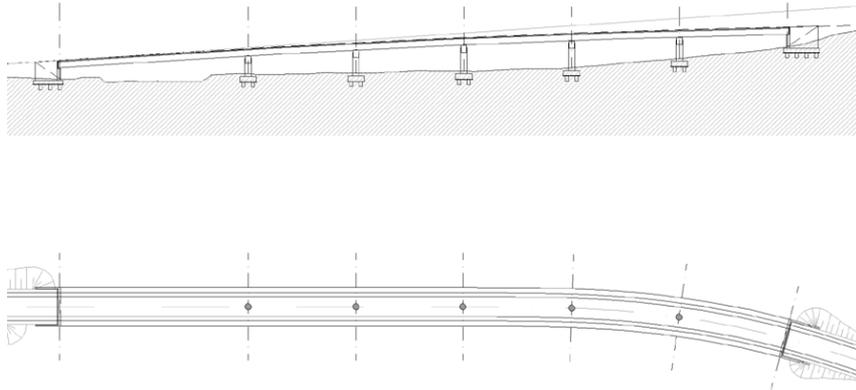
E Viadotto F.S. Asti – Chivasso – Pianta e prospetto
